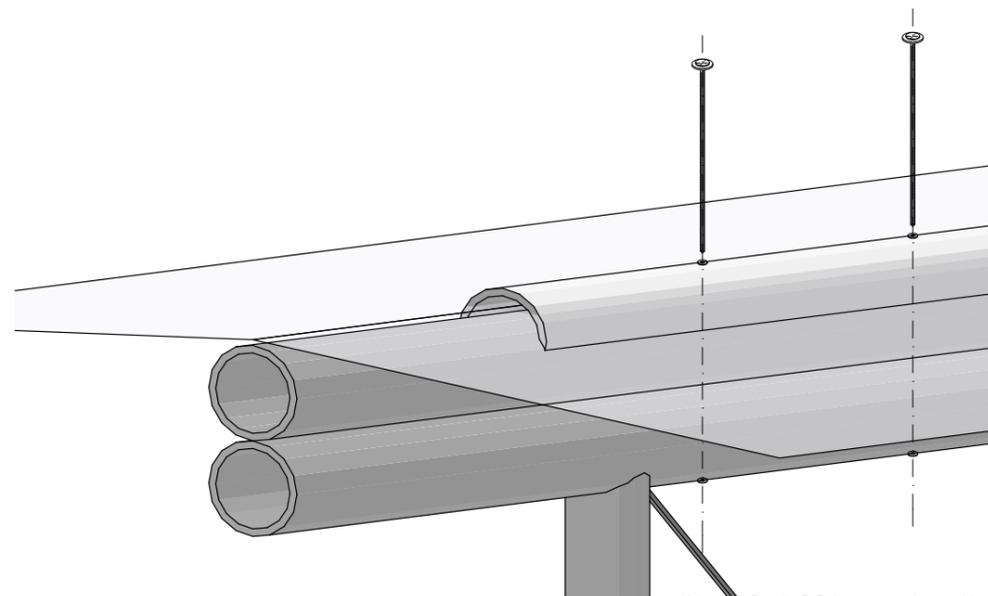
Detail 3D Polyestergewebeanschluss
